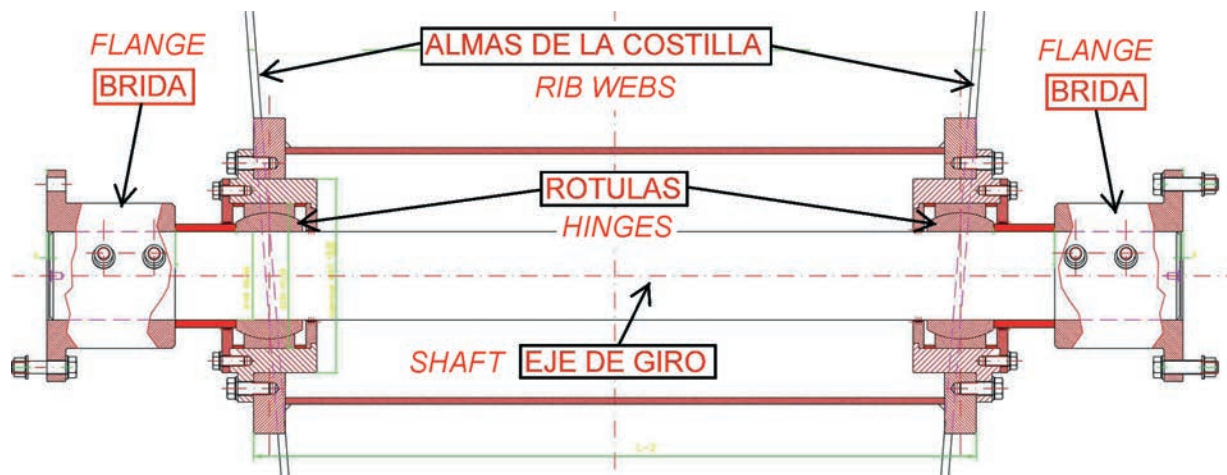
Detalle típico del sistema de arriostramiento. Ejes interiores de las costillas móviles, rótulas de giro y brida de conexión a las barras
